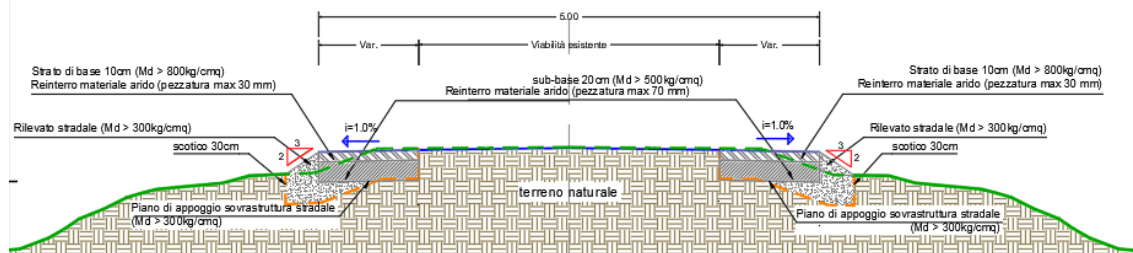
Sezione stradale tipo della viabilità esistente con adeguamenti stradali
